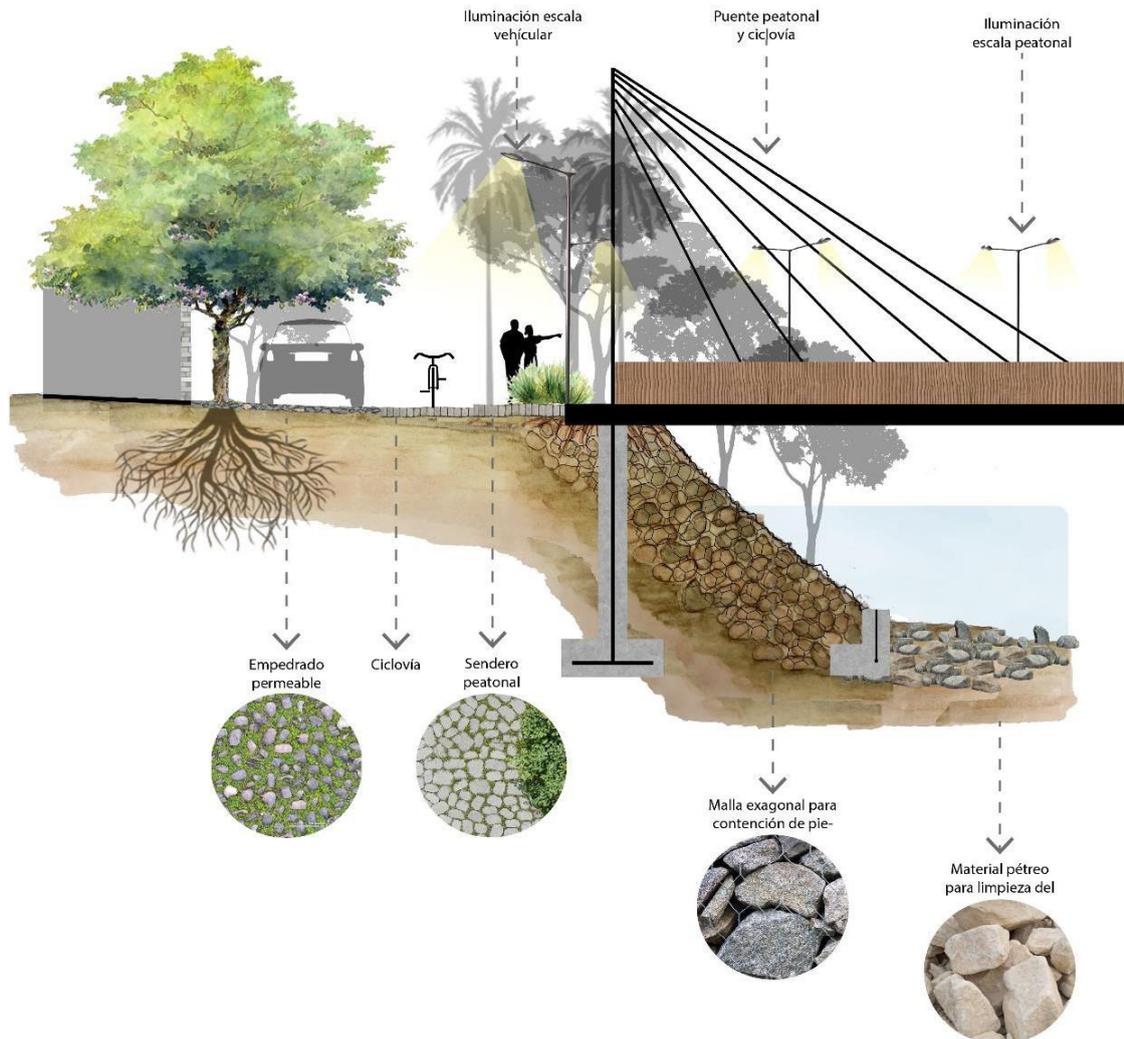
Propuesta sección detalle 2.1 - Tramo 2
